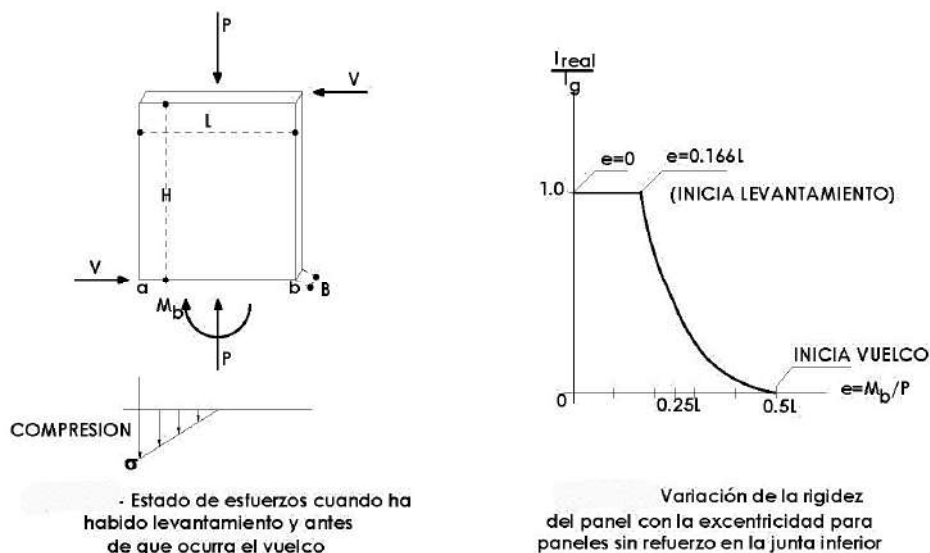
Ì Determinación de la rigidez de un muro de mampostería no reforzada en función de la carga axial existente
